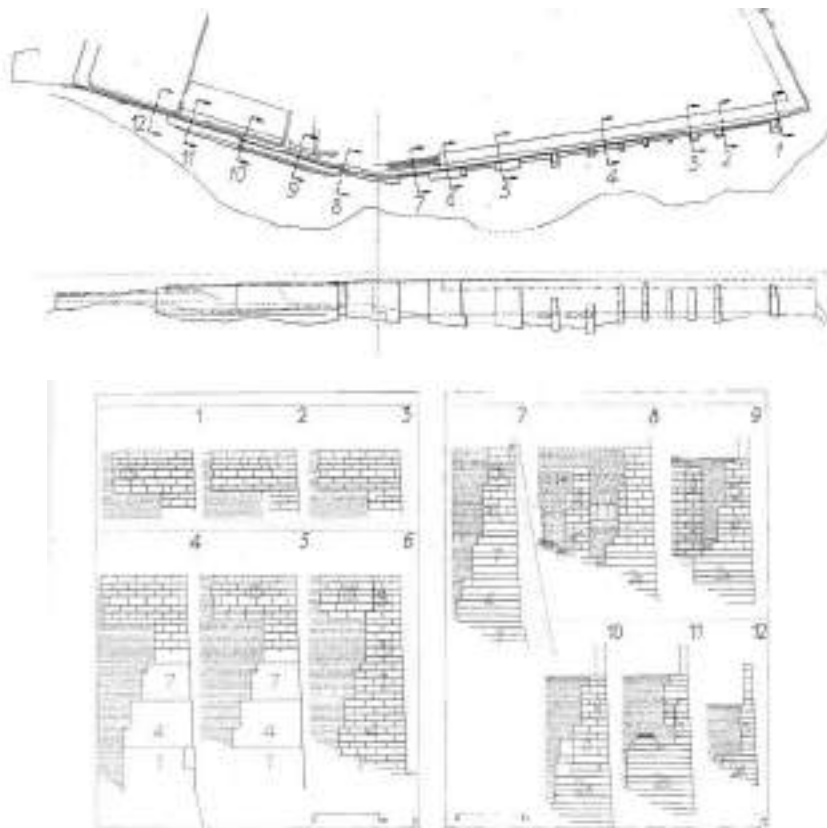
Acropoli, mura meridionali, pianta e prospetto con 12 sezioni teoriche
